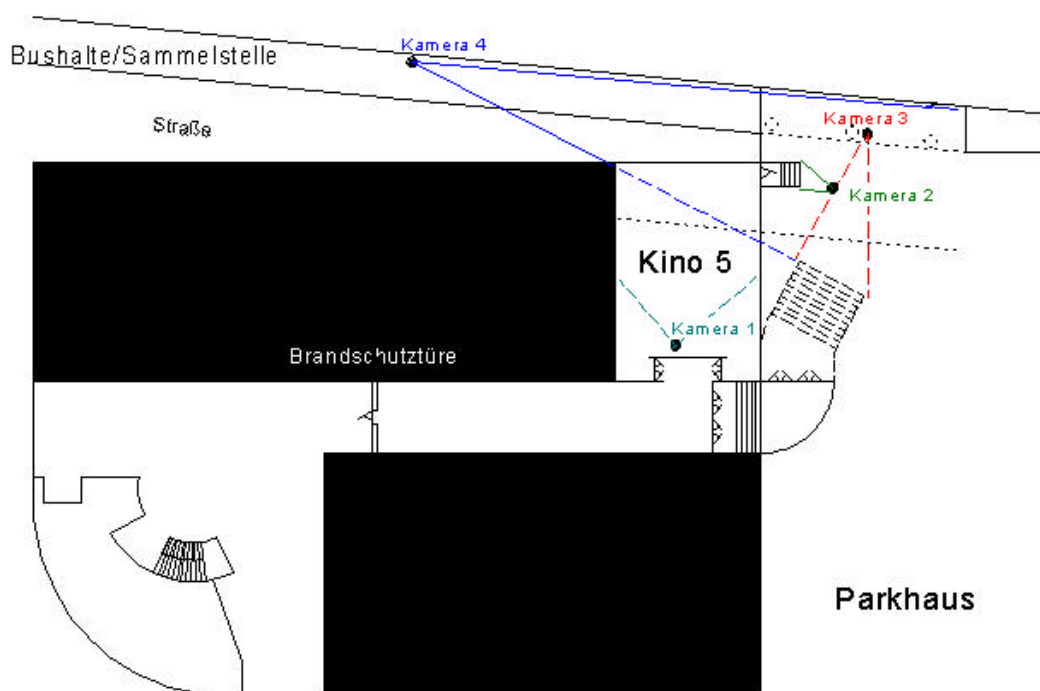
Grundriss und Standorte der Videokameras.
